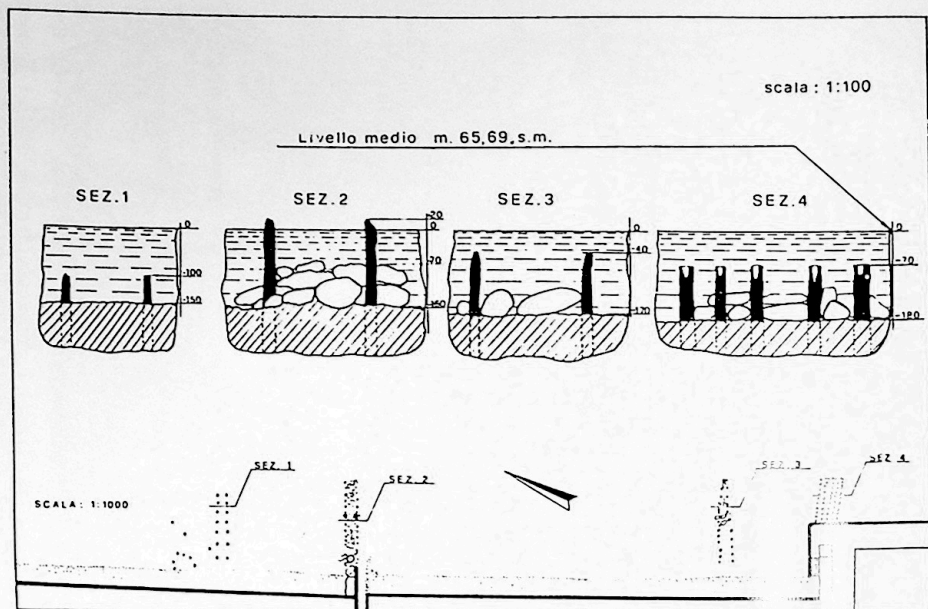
Padenghe sul Garda, sezioni e planimetria dei moli.
